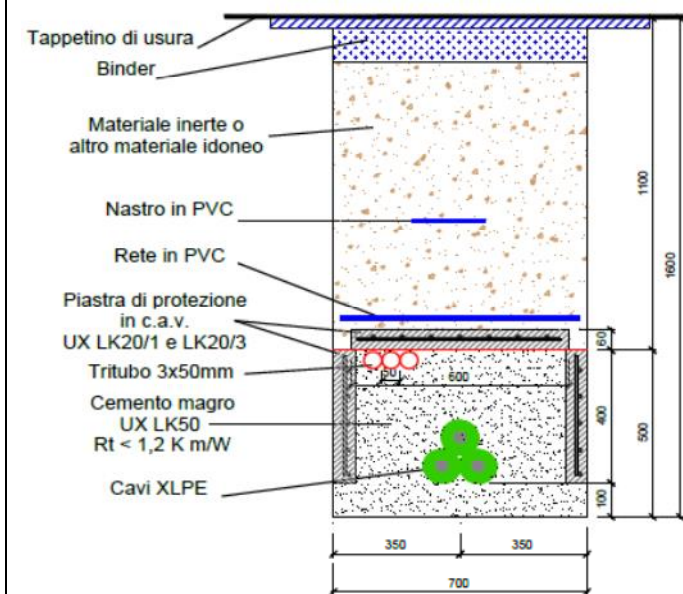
Sezione di posa del cavo interrato in sede stradale
